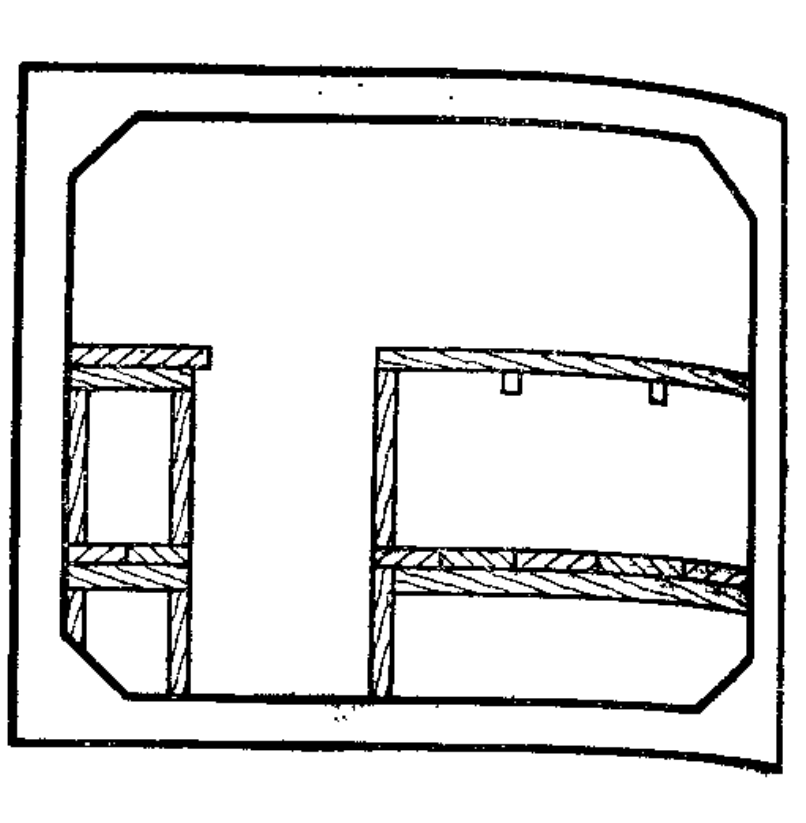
Убежища из замкнутых железобетонных блоков.
